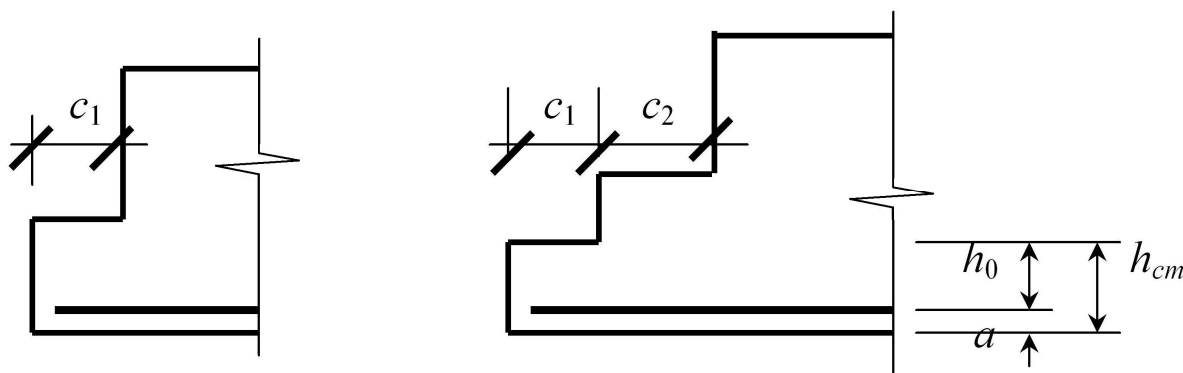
Расчетная схема для определения количества арматуры
